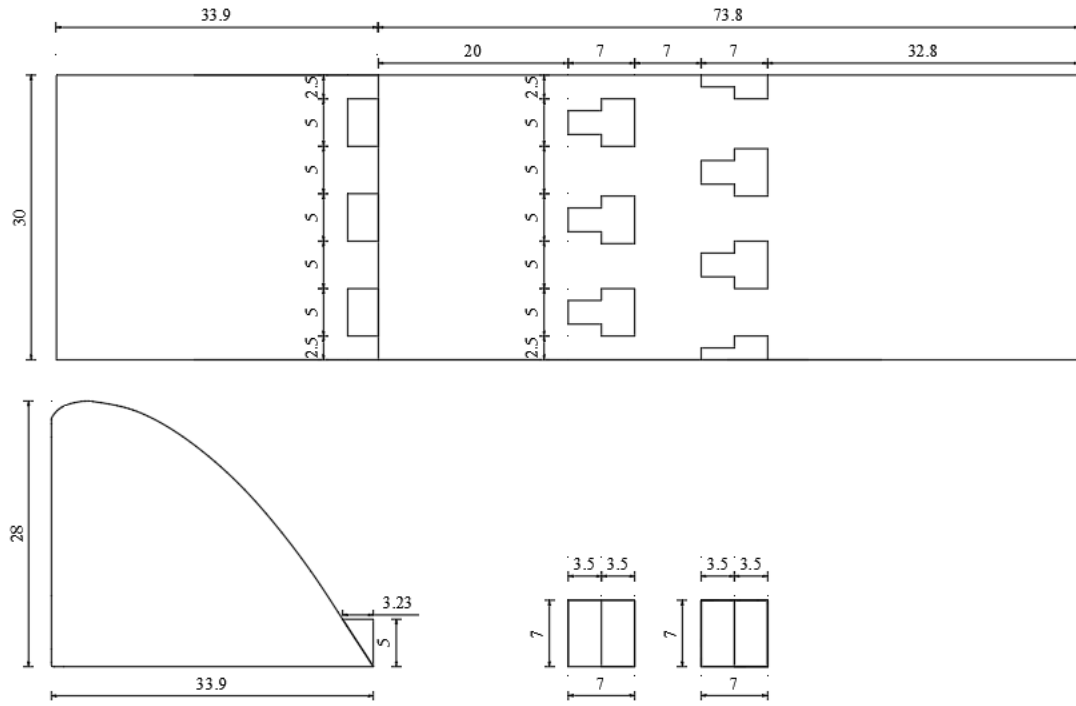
Trapez kesitli çift sıra eşiksiz enerji kırıcı blokların yerleşim planı
